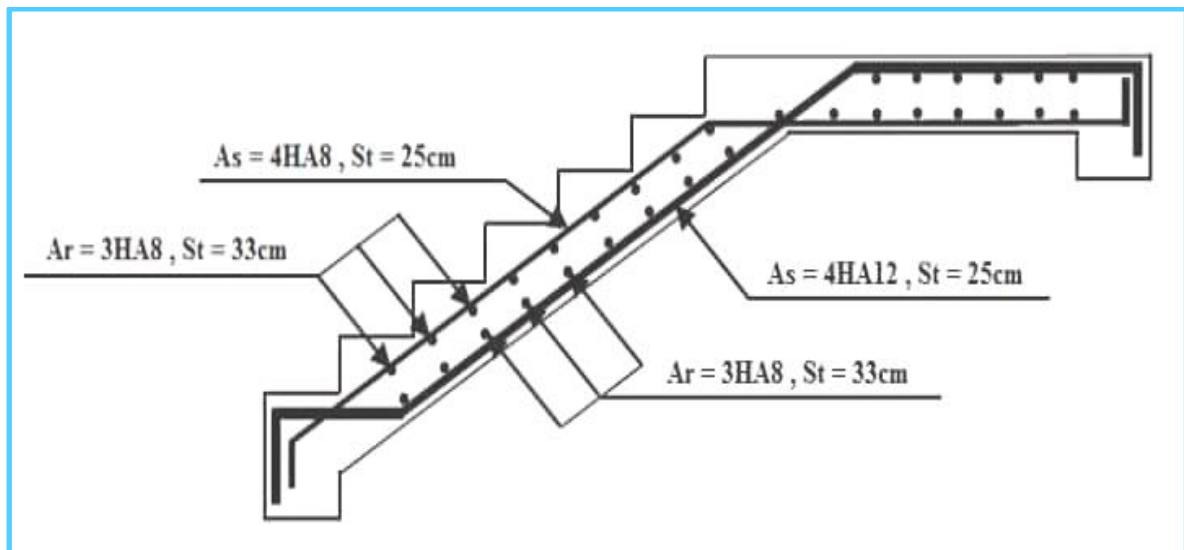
schéma de ferrailage d'escalier RDC type 02 du volée 01.
